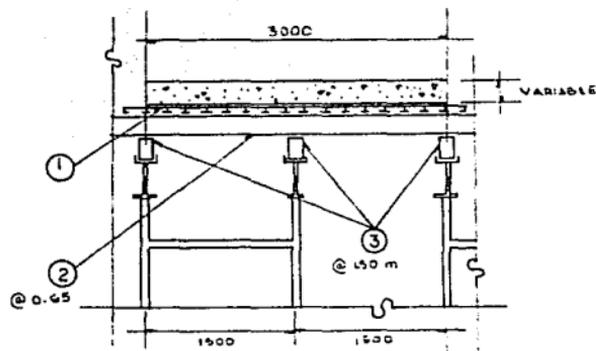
Cimbra en losas - Secc. Transversal -
